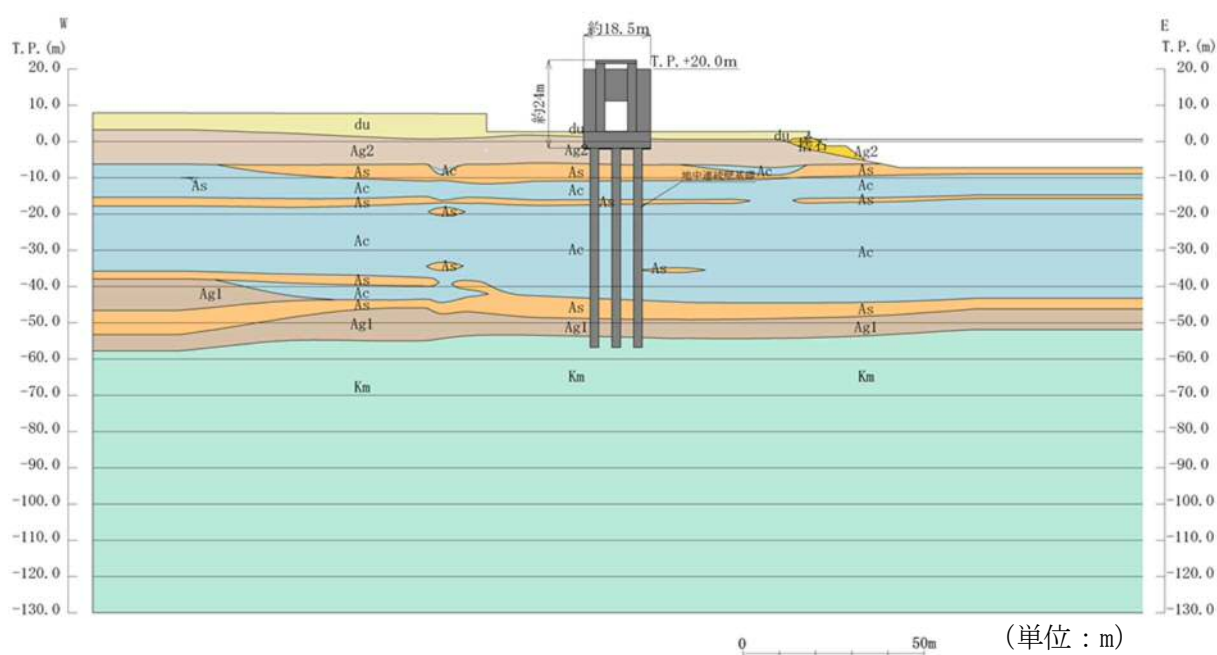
(2) 鉄筋コンクリート防潮壁 評価対象断面図 (②-②断面)
